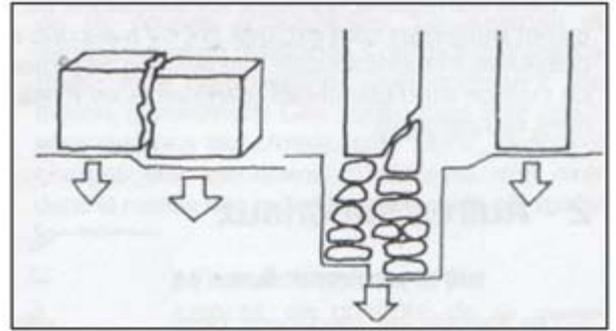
tassement différentiel engendrant la déstabilisation de la fondation
